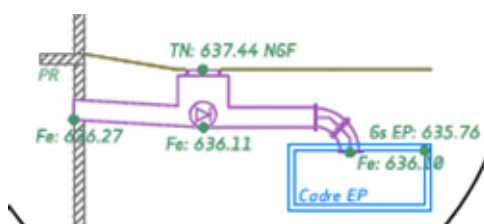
Plan de détail (coupe) du trop-plein du poste de relevage principal dans la buse cadre pluviale (Source : CEREG, PRO, Juin 2023)
